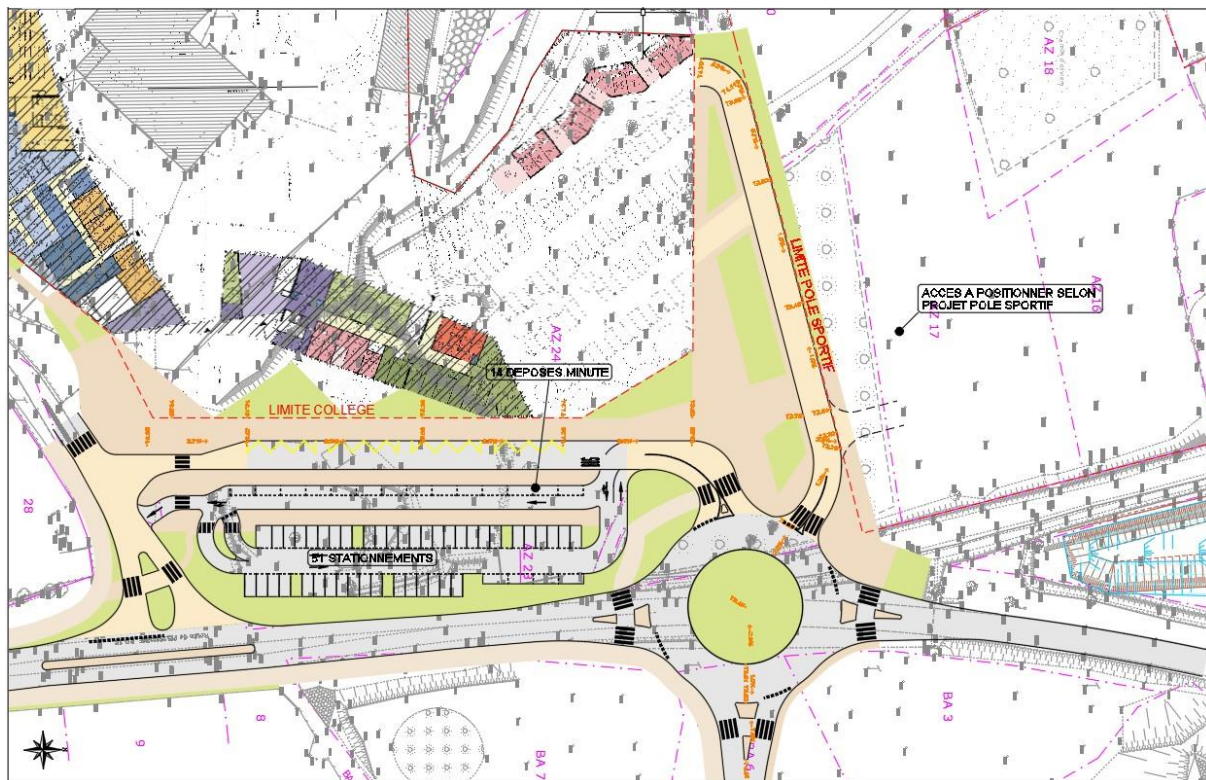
Raccordement viaire du site depuis la RD 15 – au stade Etudes préliminaires (source SERI)
